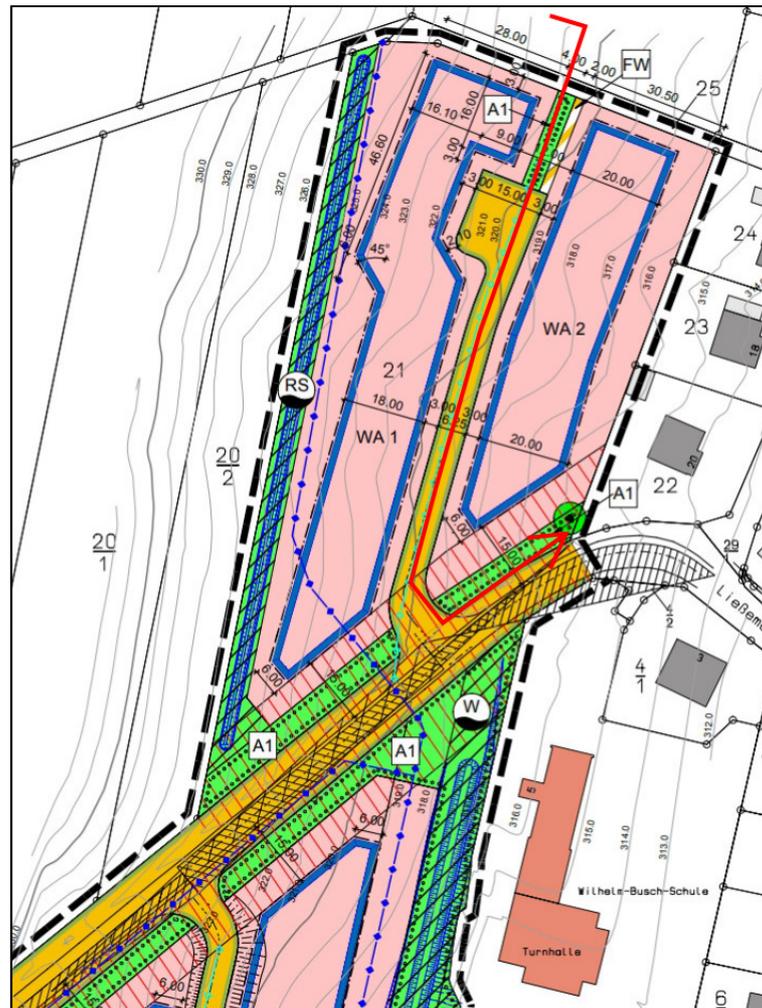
Ausschnitt aus dem B-Plan mit möglichem Notwasserweg
